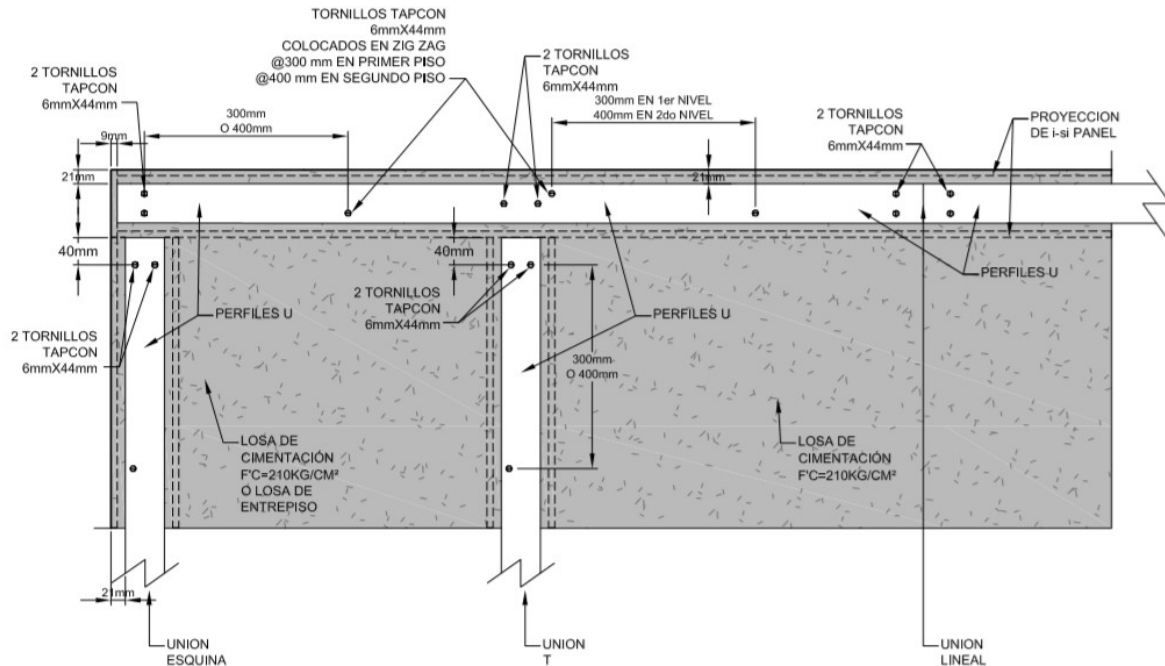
Anclaje de perfil tipo canal en piso - Panacor.
